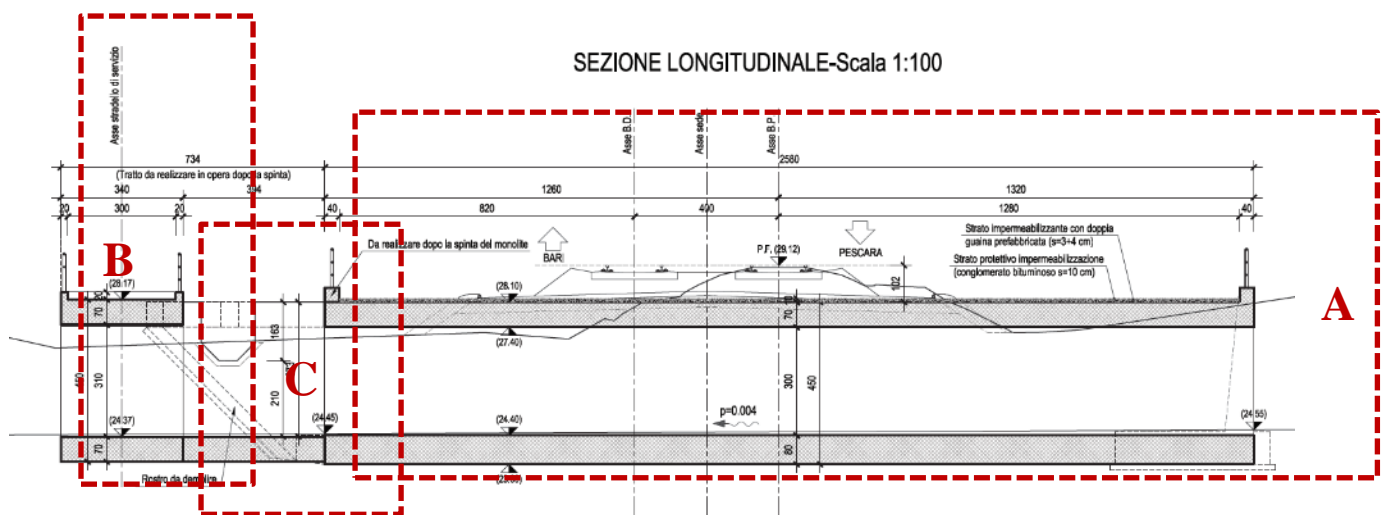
Adeguamento idraulico Fosso Pontonicchio - Sezione Longitudinale sul sovrappasso stradale, sul monolite e sul manufatto di raccordo
